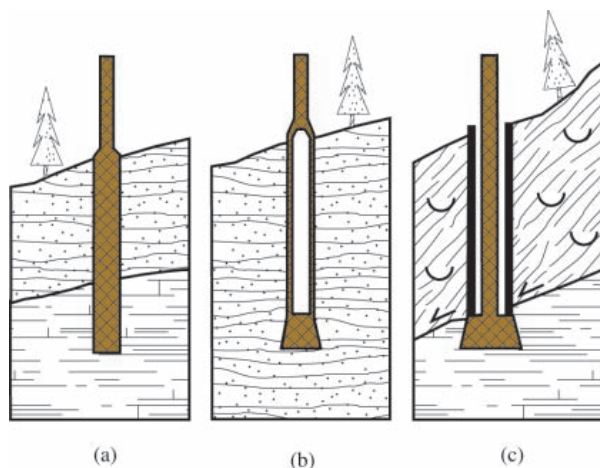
Fondazioni delle pile di un ponte: (a) pila semplice in cemento pieno che attraversa un terreno di copertura stabile. Tipologia adatta a substrati con buona capacità portante; (b) pila leggera, cava, a zampa di elefante, per terreni stabili ma con ridotta capacità portante; (c) pila incamicciata per terreni di copertura in scivolamento attivo
